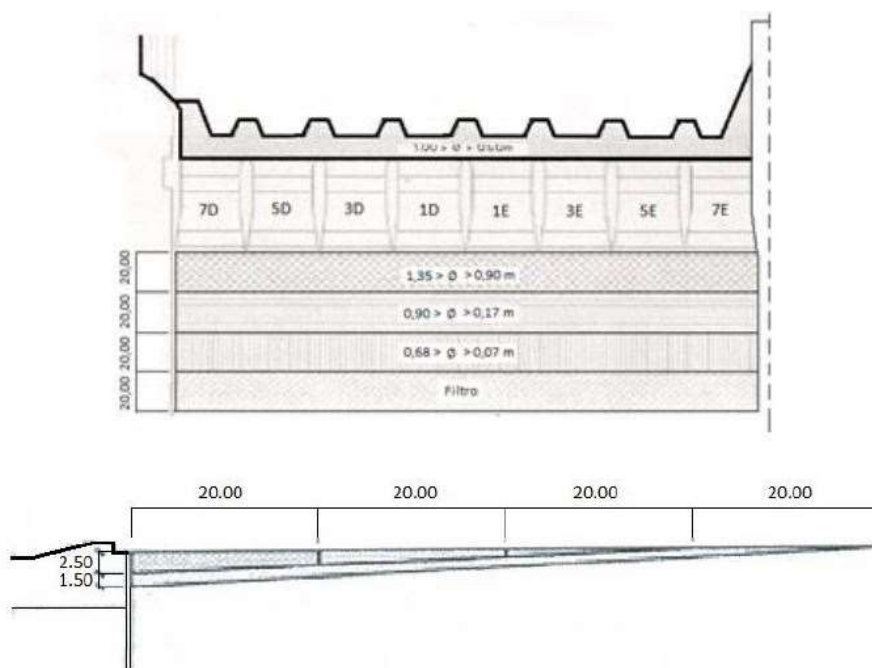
Esquema do tapete de proteção em planta e corte, respetivamente [9].
